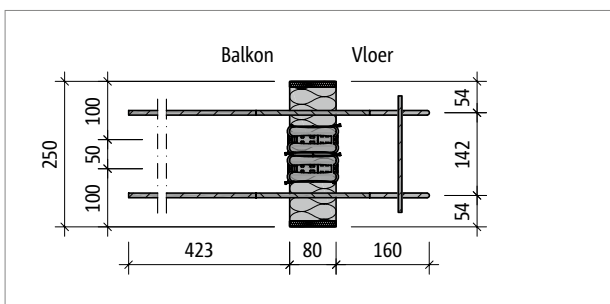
Schöck Isokorb® T type Q-E-V4-L500: Bovenaanzicht
